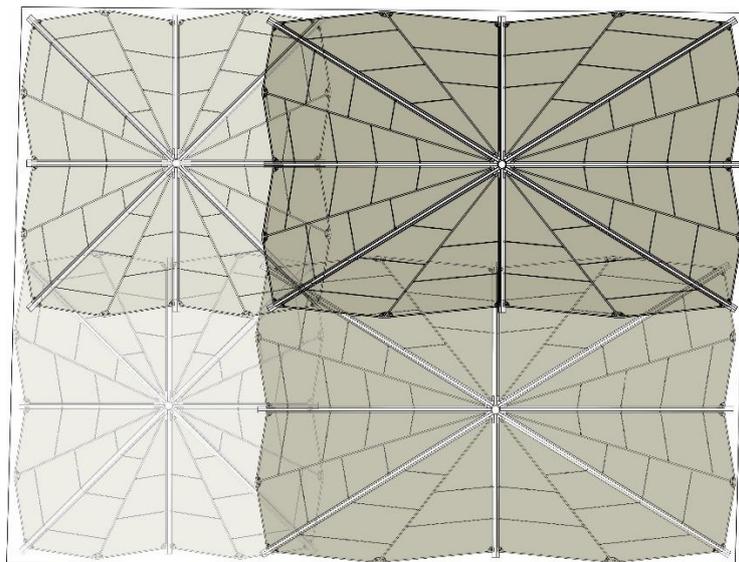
Vista superior das estruturas em relação ao espaço delimitado para a implantação da cobertura no edifício.
